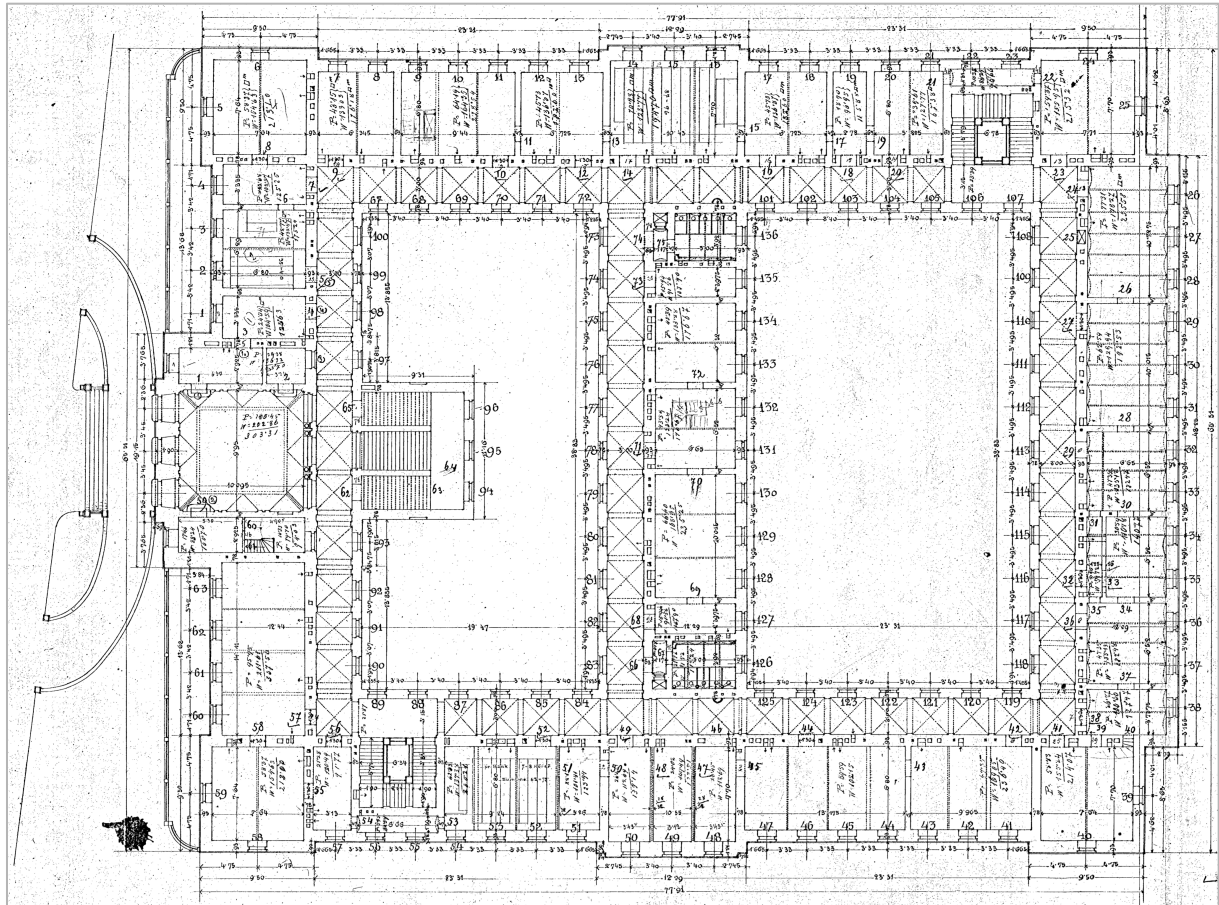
Darstellung des Grundrisses des Erdgeschoßes der Alten Technik (Original Planscan)
